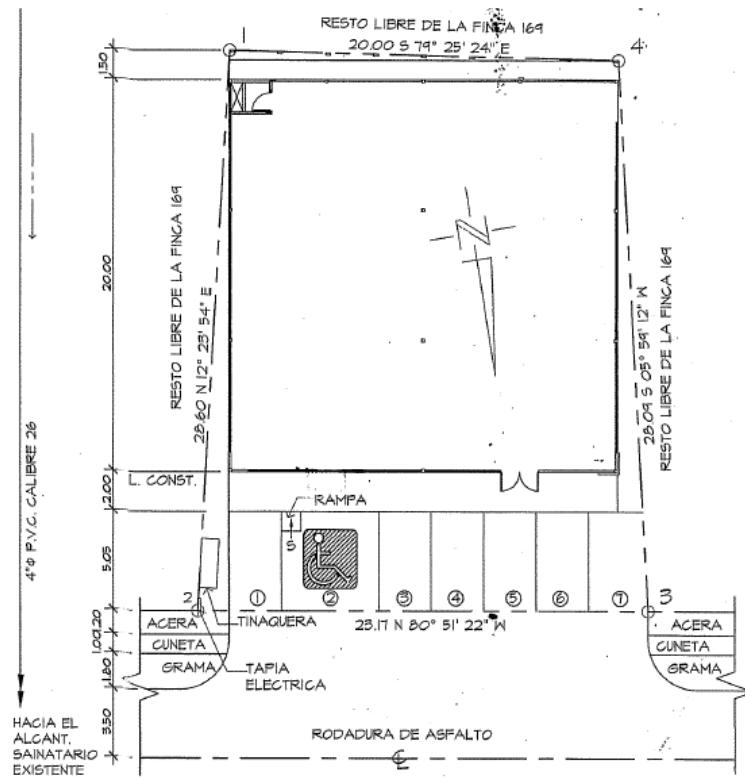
Vista del local comercial a construir en la finca No. 13913
